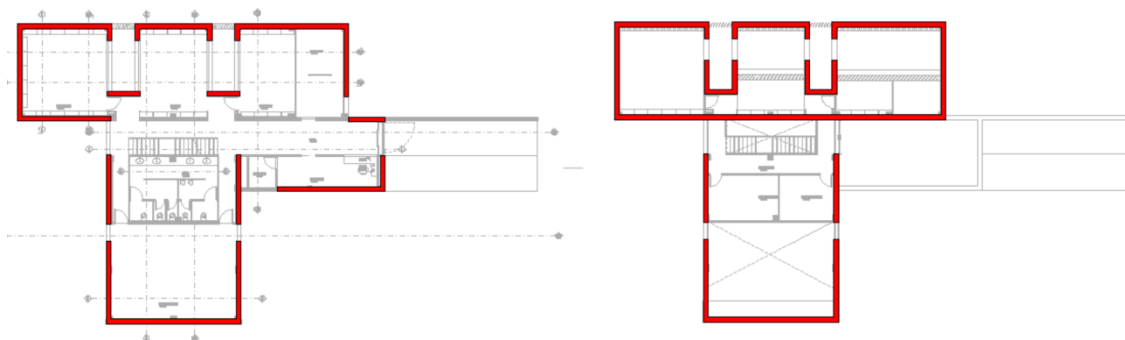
Donde se muestra donde se encuentra Fachada de fabrica con trasdosado auto-portante
